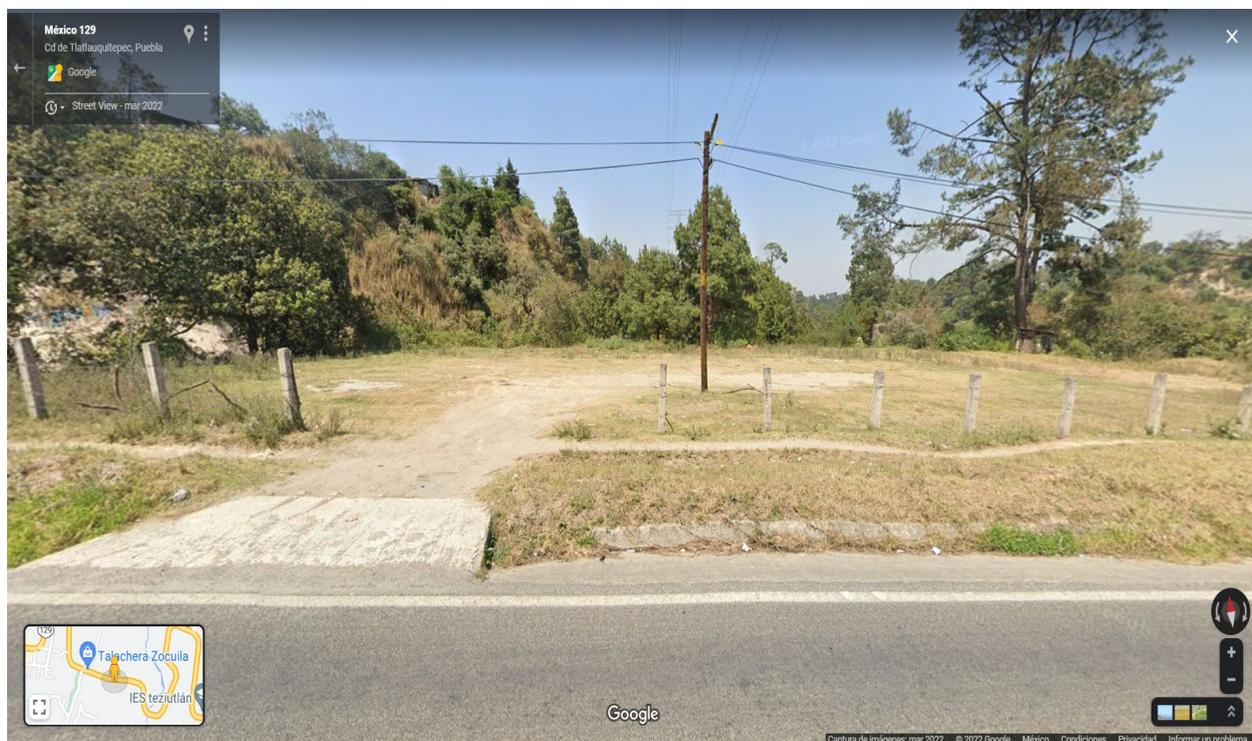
Vista actual del área del proyecto desde la carretera federal Teziutlán-Puebla, año 2022
